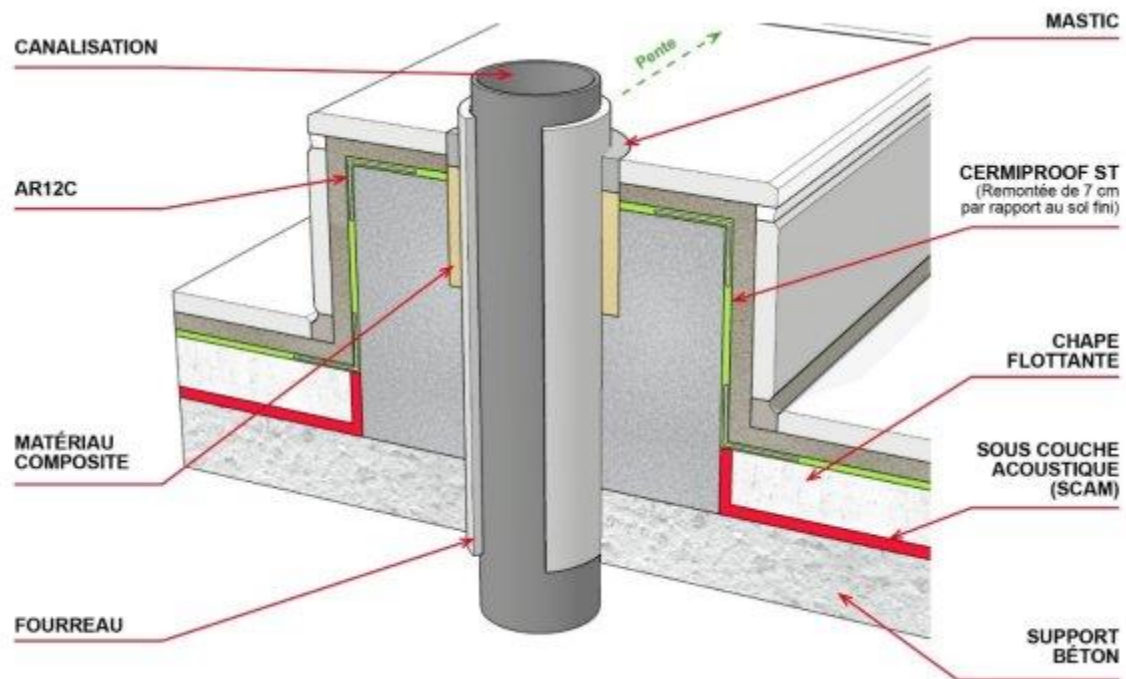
Traitement d'une canalisation traversante en sol en pose collée sur SCAM
